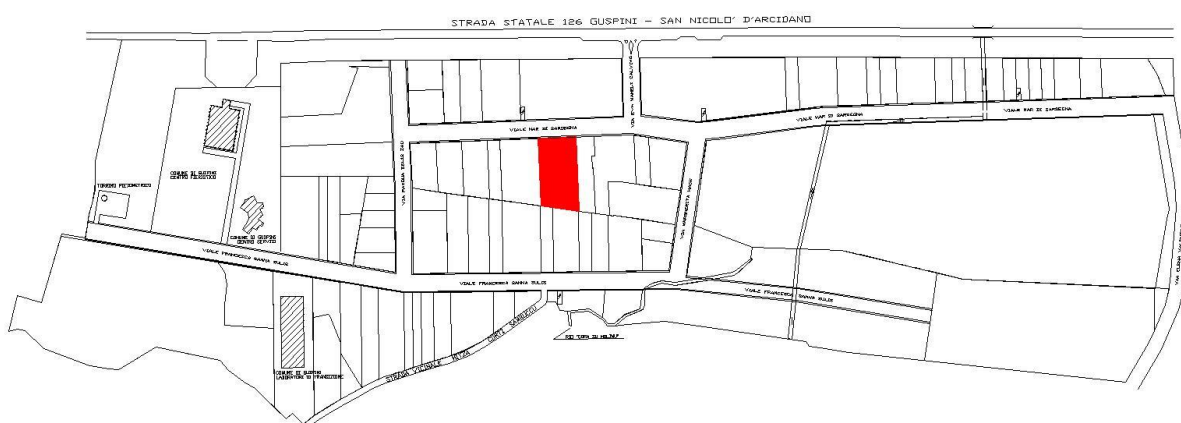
Planimetria – Piano Insediamenti Produttivi
